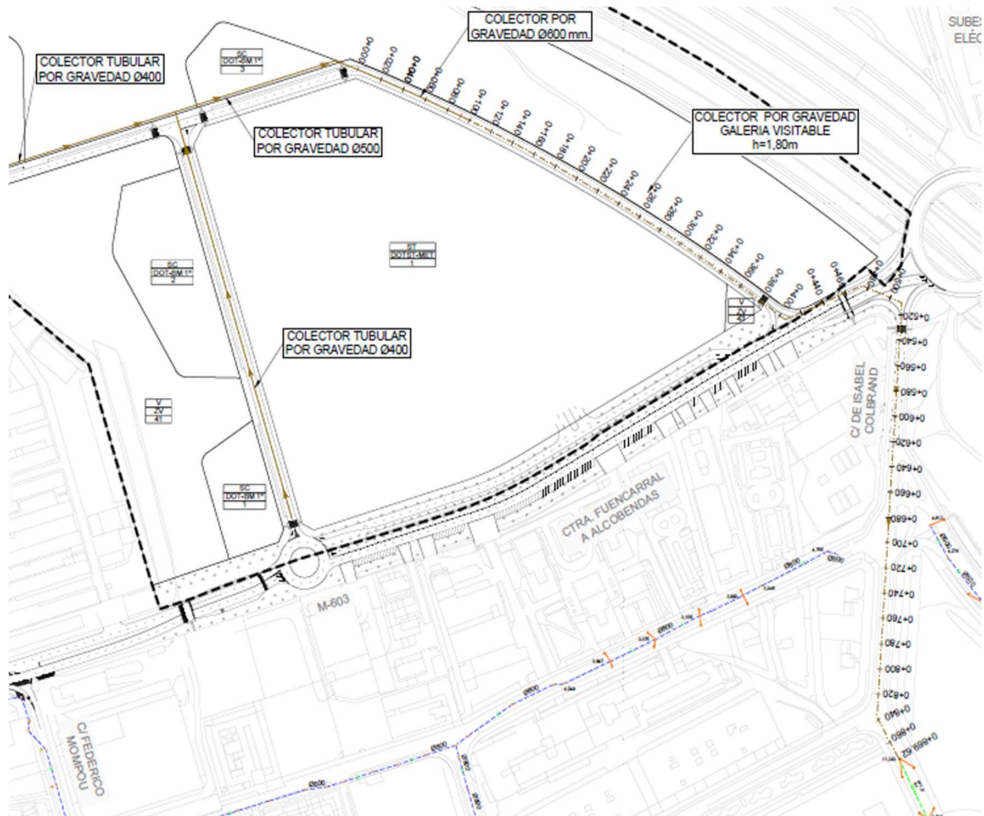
Planta de la red de recogida de aguas residuales. alternativa por gravedad
